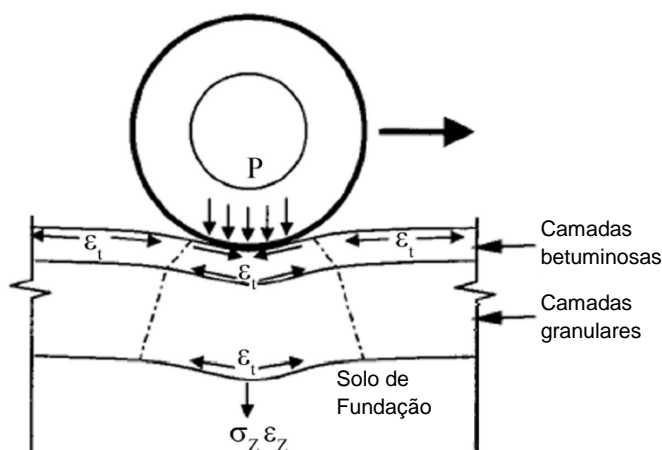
Resposta de um pavimento flexível sujeito a uma carga uniforme “P”
